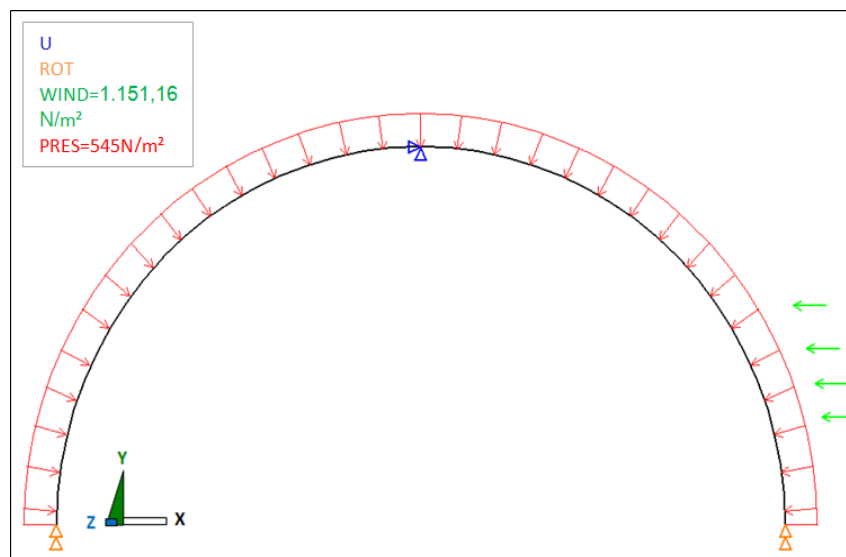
Estrutura com carregamentos e vinculações aplicados, plano Y
